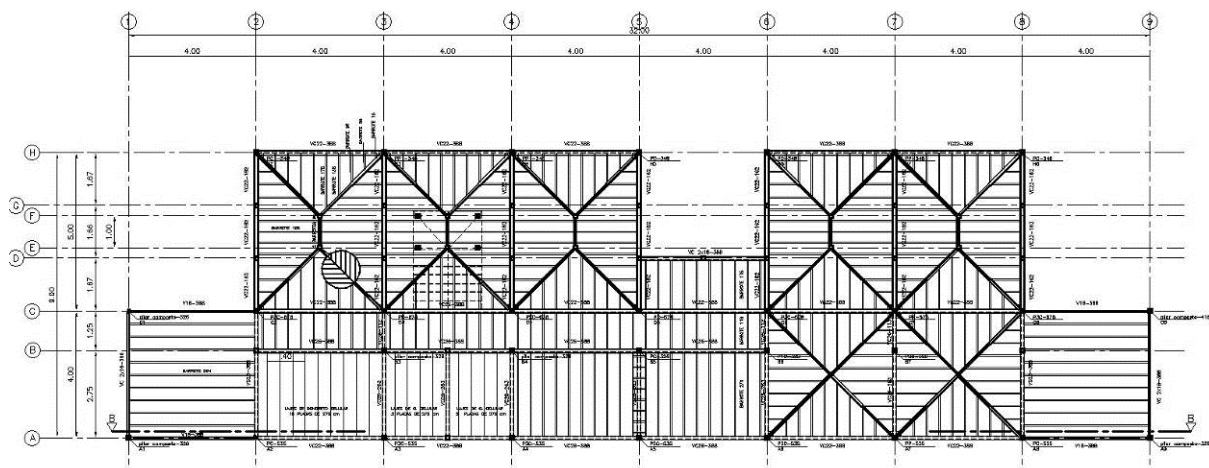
IMAFLORA I - Planta de barroteamento de piso. Fonte: Elaborada pelos autores.
